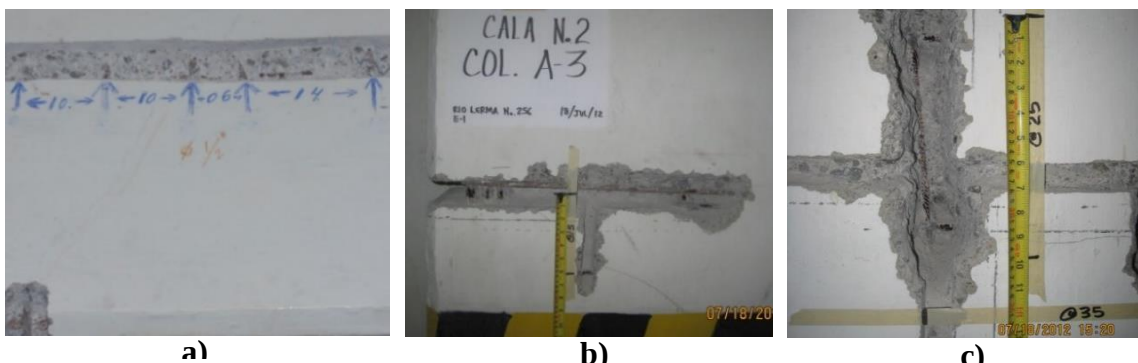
Calas en los elementos estructurales: a) trabes, b) columnas y c) muros de concreto.
